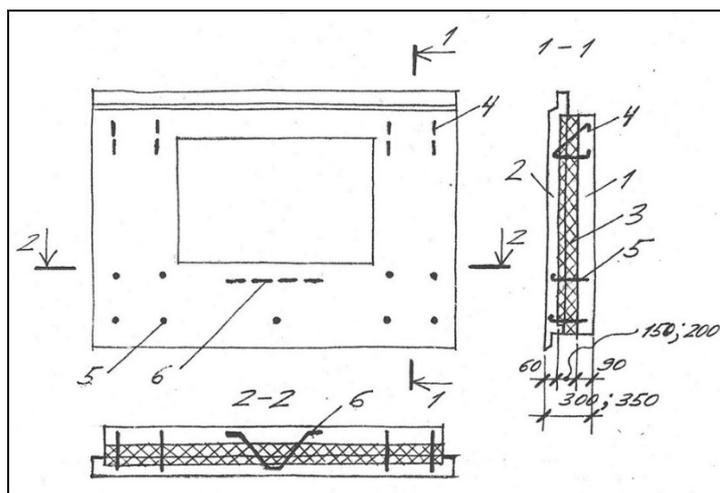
Принципиальное конструктивное решение крупной наружной трехслойной стеновой панели с гибкими связями; 1 – внутренний бетонный слой, 2 – наружный бетонный слой, 3 – эффективный утеплитель, 4 – связь-подвеска, 5 – связь-распорка, 6 – связь-подкос; армирование бетонных слоев условно не показано
